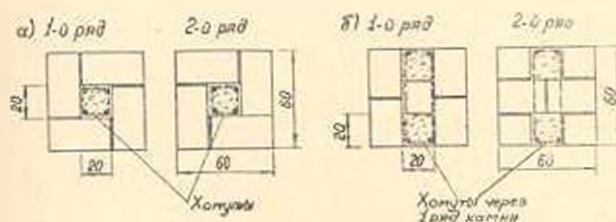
Конструкция образцов с внутренним (а) и наружным (б) расположением железобетона в сечении
